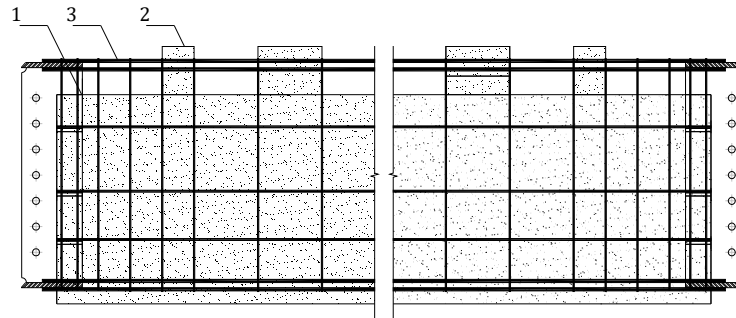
梁端负弯矩区钢筋参与施工阶段受力的构造示意
